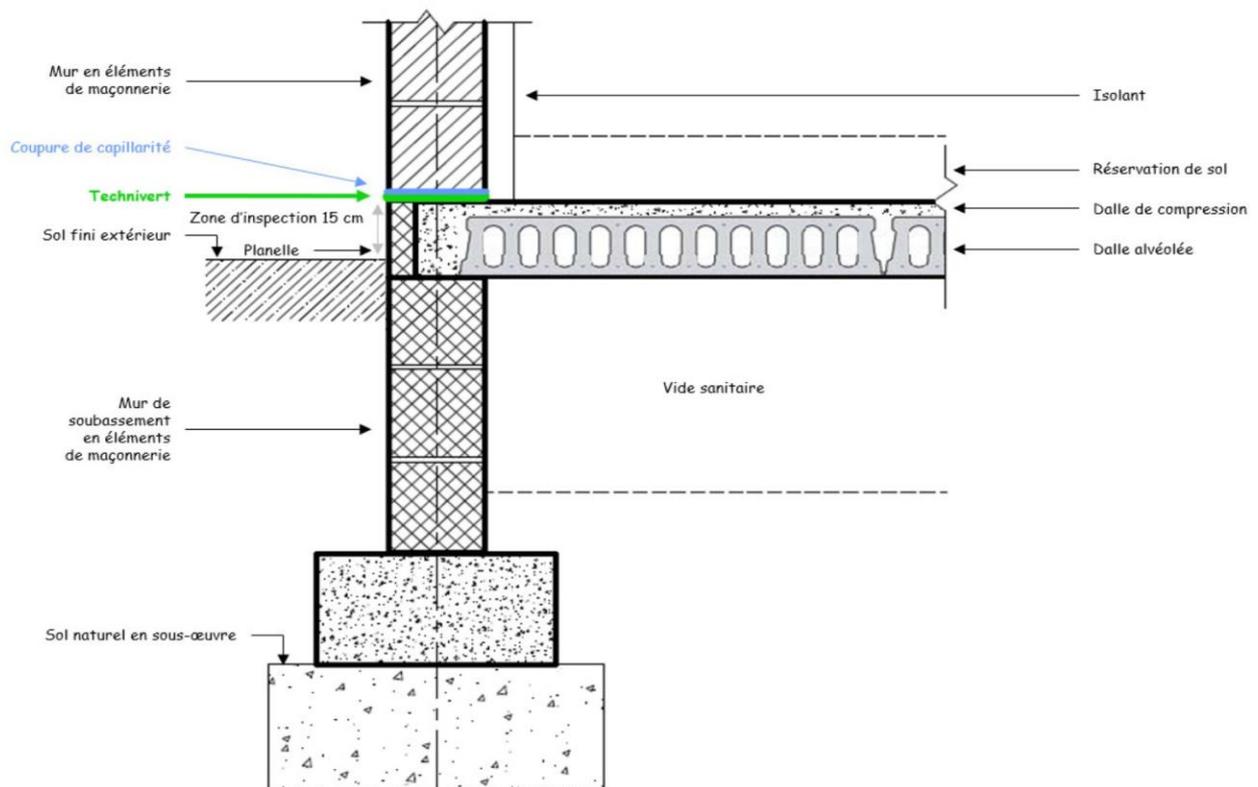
Plancher à dalles alvéolées préfabriquées en béton - Elévations maçonneries
